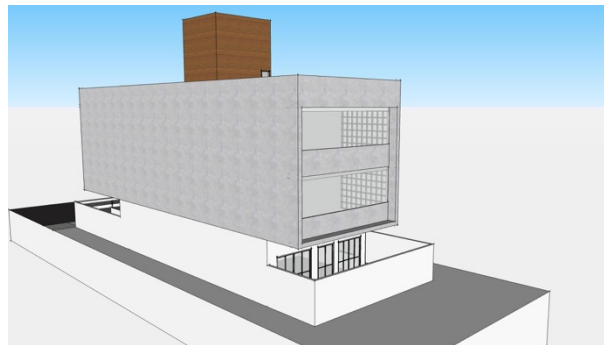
Fachadas com aplicação do Revestimento em Pintura
